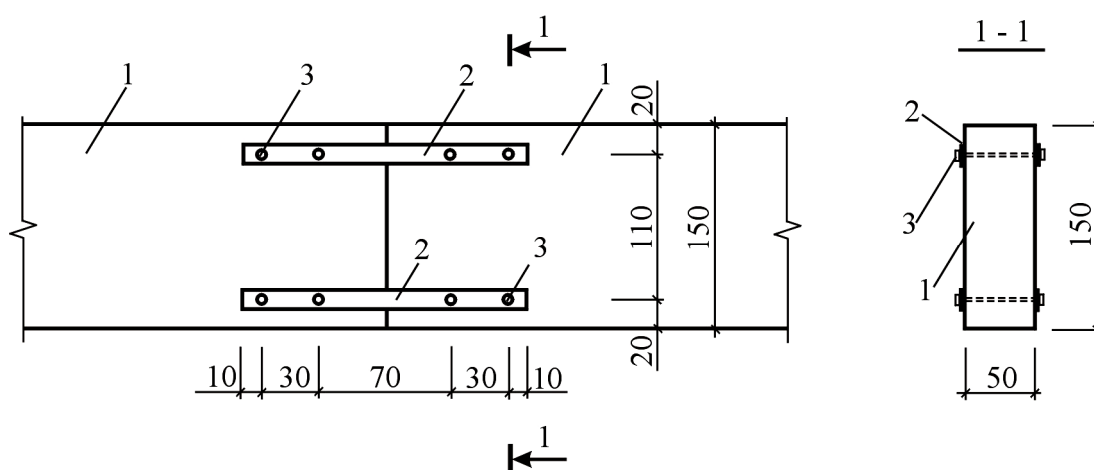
Конструкция укрупнительного стыка деревянной балки
